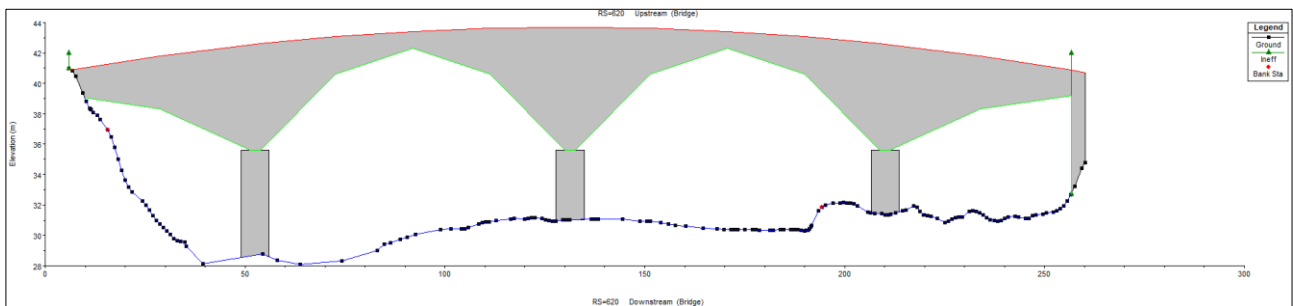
Sezione idraulica del ponte proiettata sul piano ortogonale al deflusso della corrente
